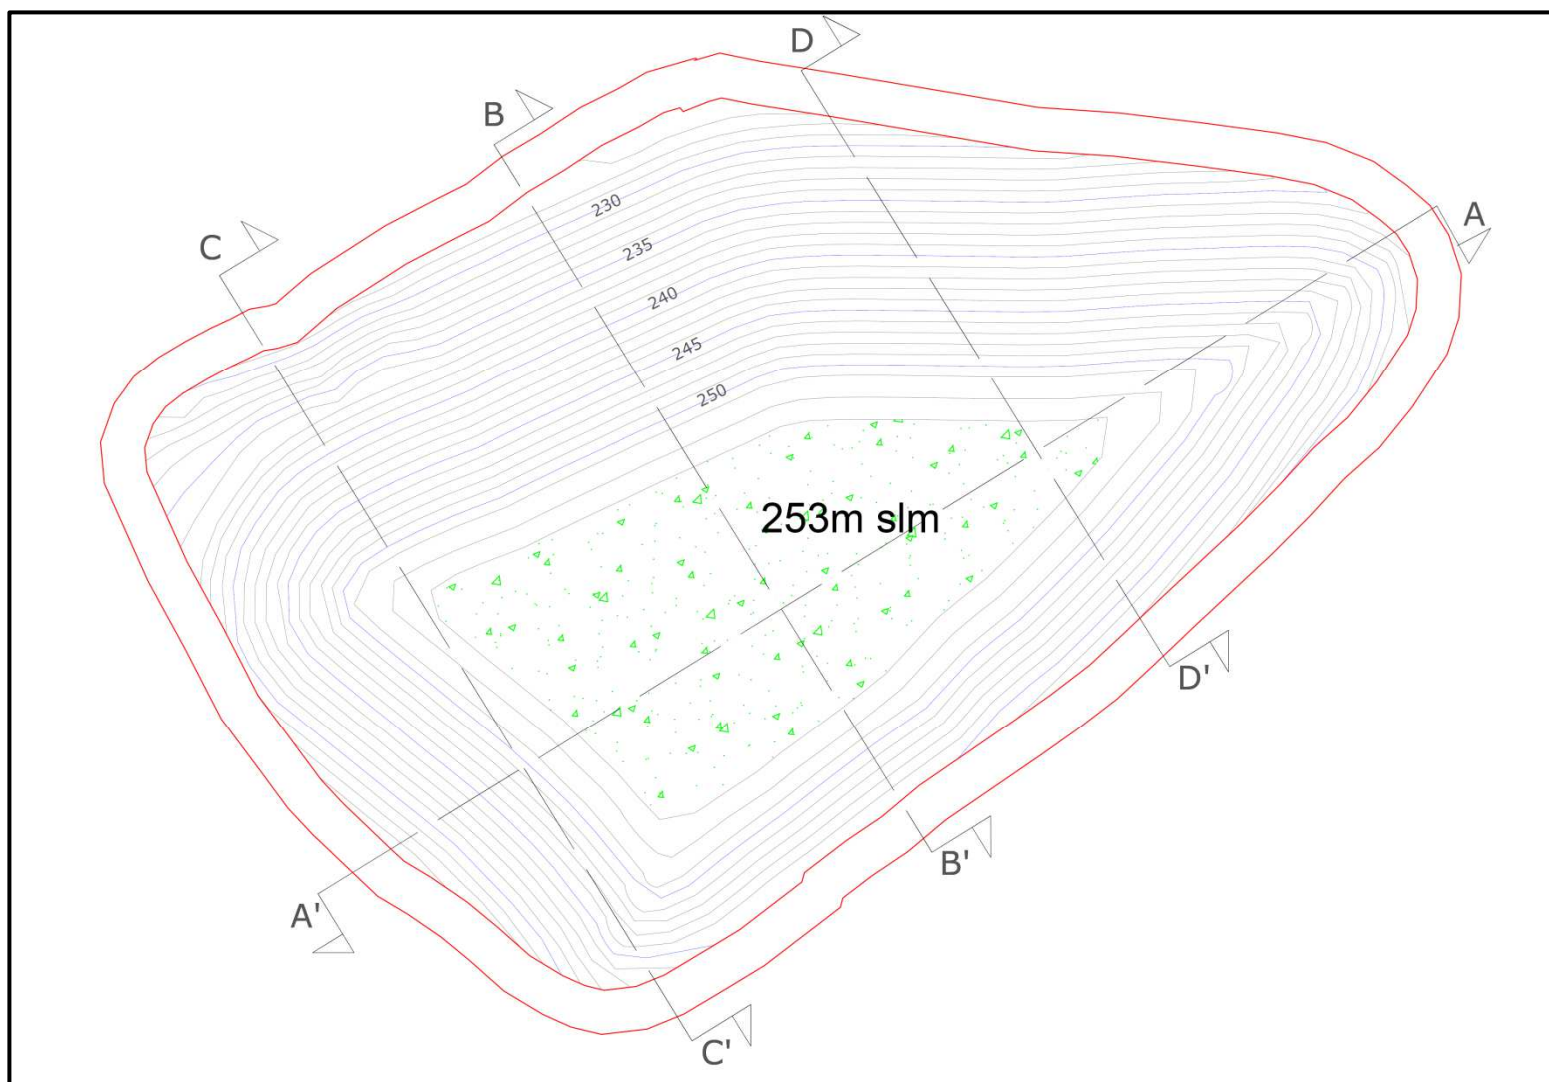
/III: Planimetria modulo 7 autorizzato, con colmata a +253 m slm
